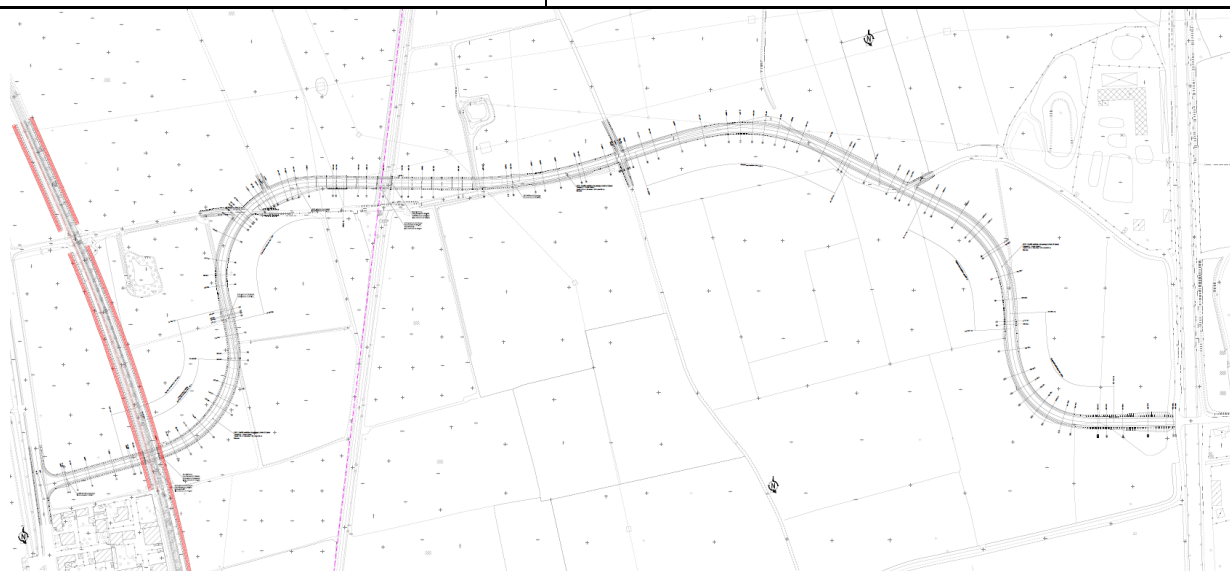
TRACCIATO PLANIMETRICO VIABILITÀ NV02
